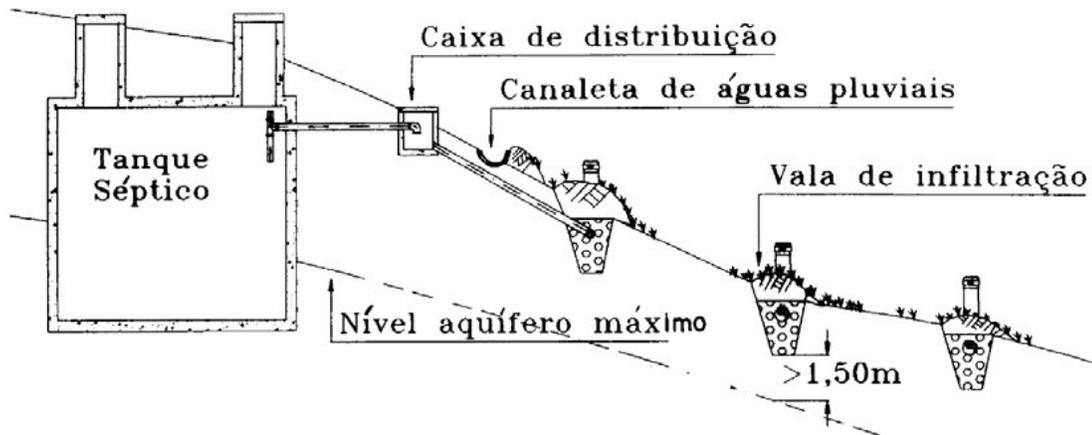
Exemplo de instalação de Valas de Infiltração
